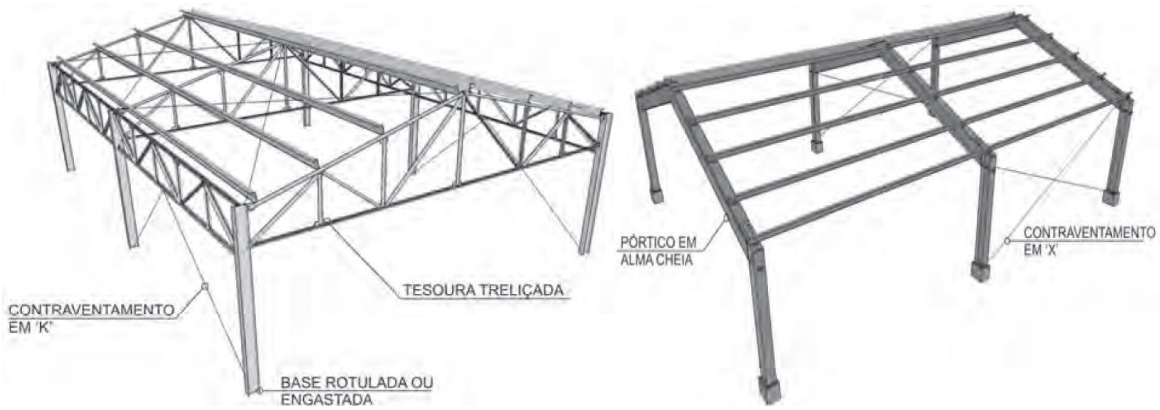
Disposição das peças de um telhado de telhas metálicas/ fibrocimento.
